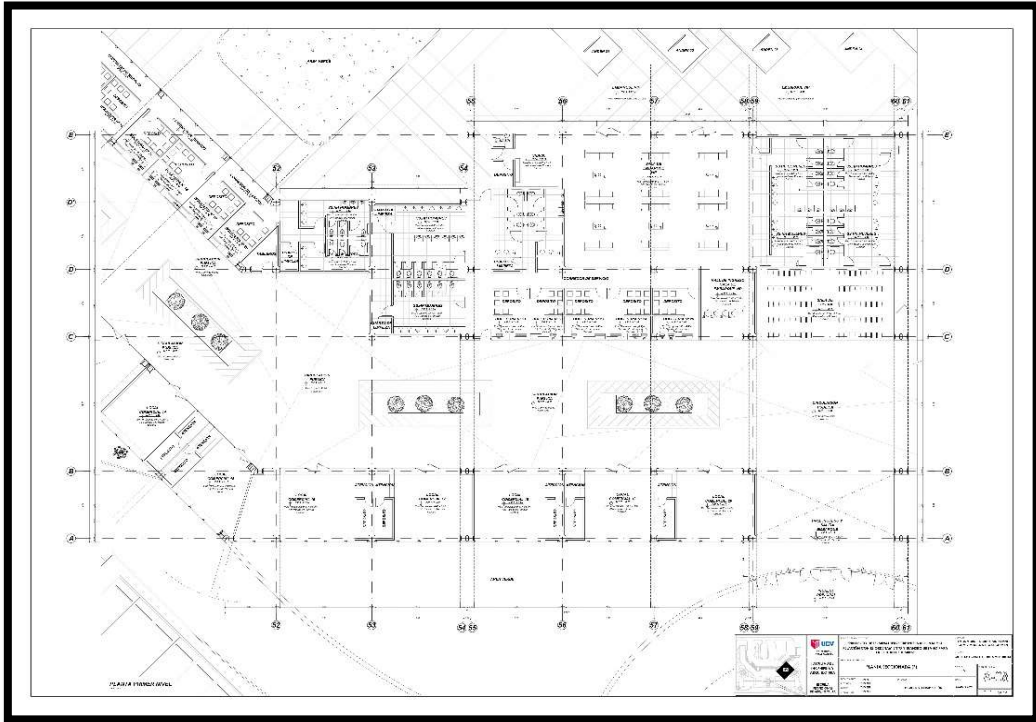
Plano Planta sector (F) Primer Nivel Fuente: Elaboración Propia.
